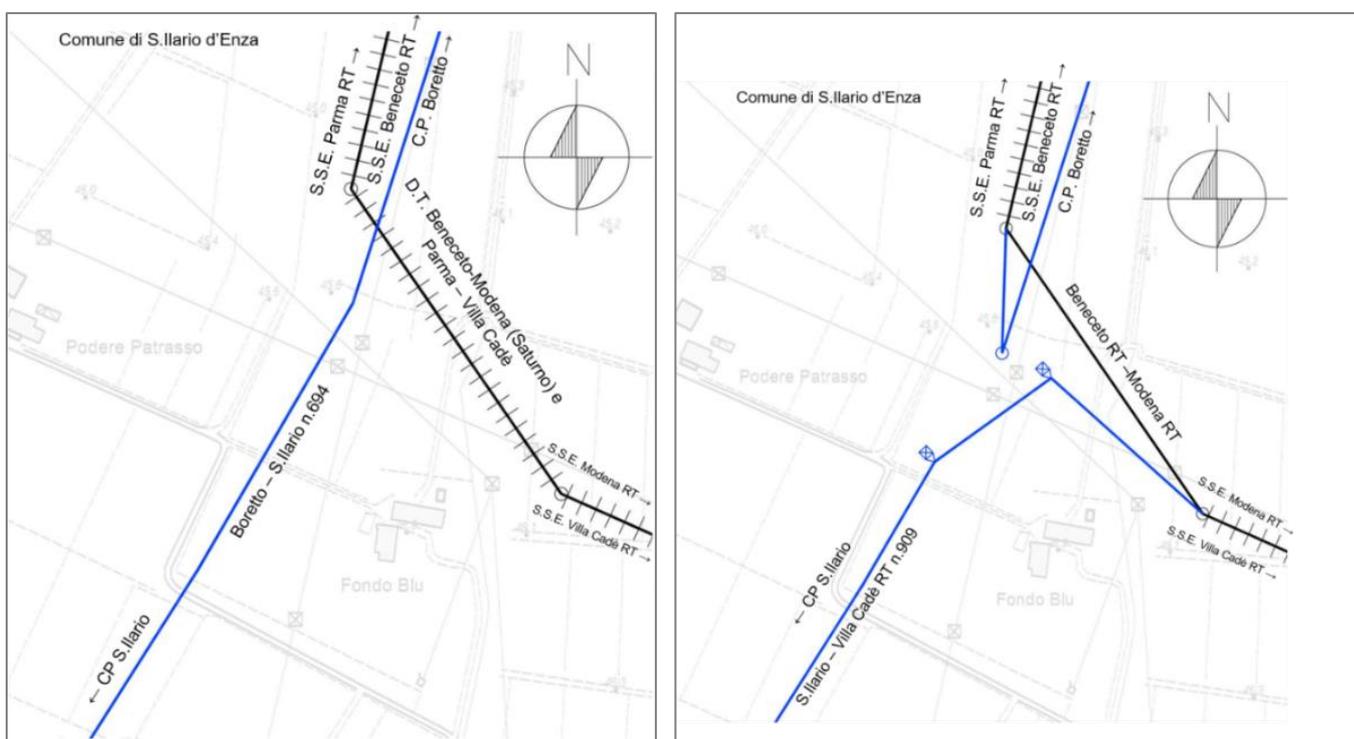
A sinistra: stato attuale dell'intervento SI2, a destra: stato futuro dell'intervento SI2
